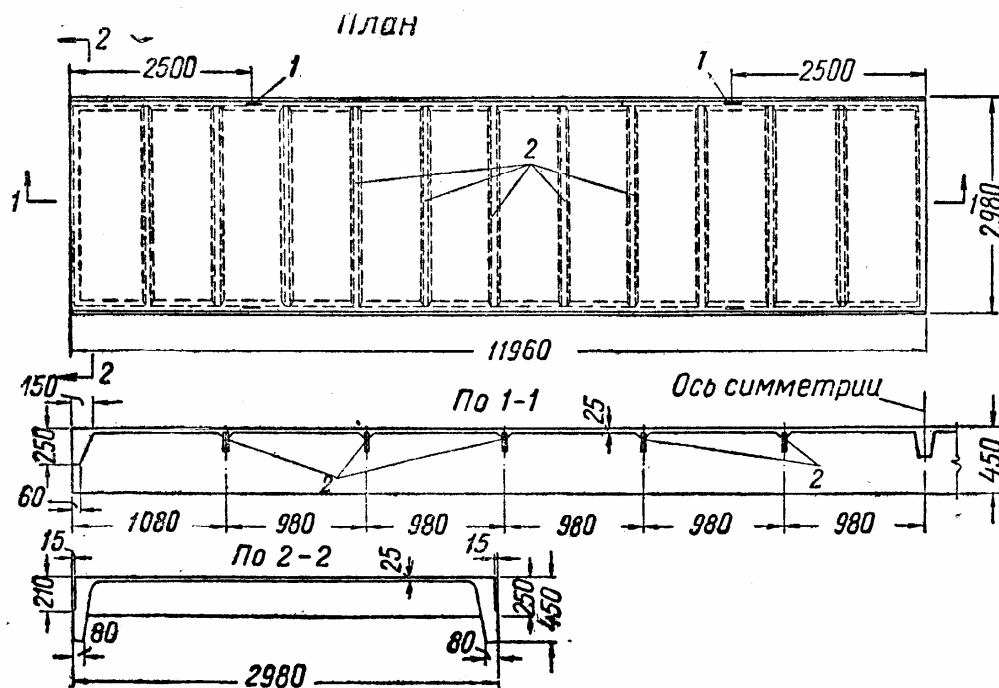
Конструкция железобетонной плиты размером 3×12 м
